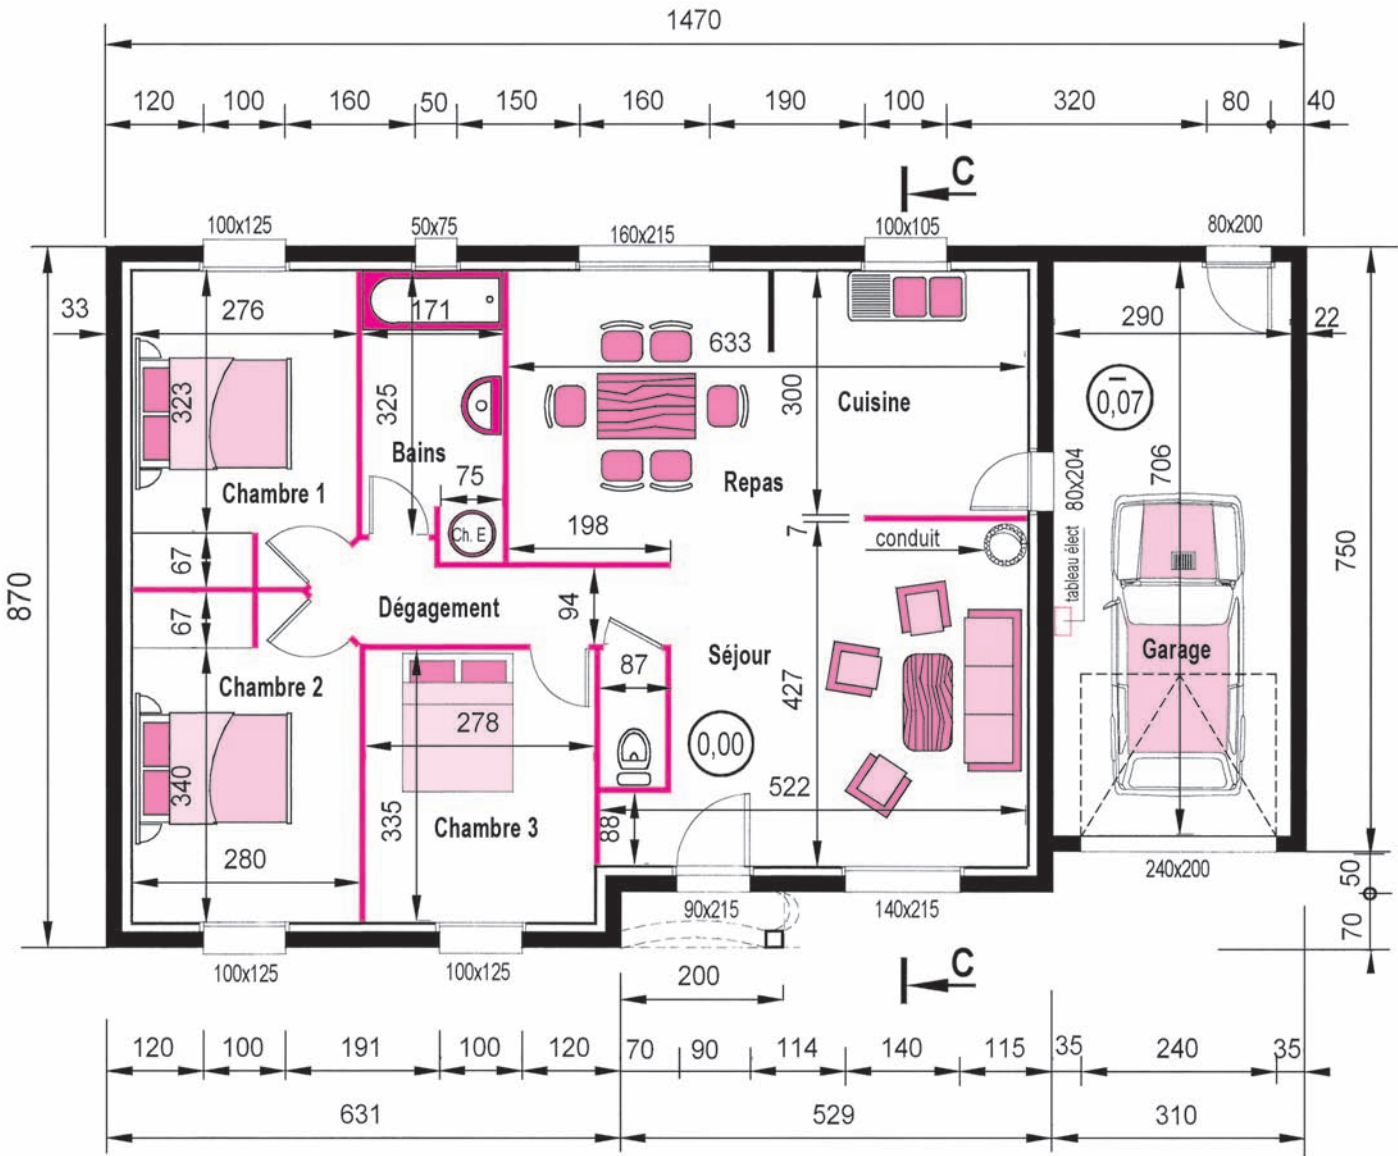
Plan de maison de plain-pied, type 4/5, avec la zone nuit bien distincte de la zone jour, garage en annexe
